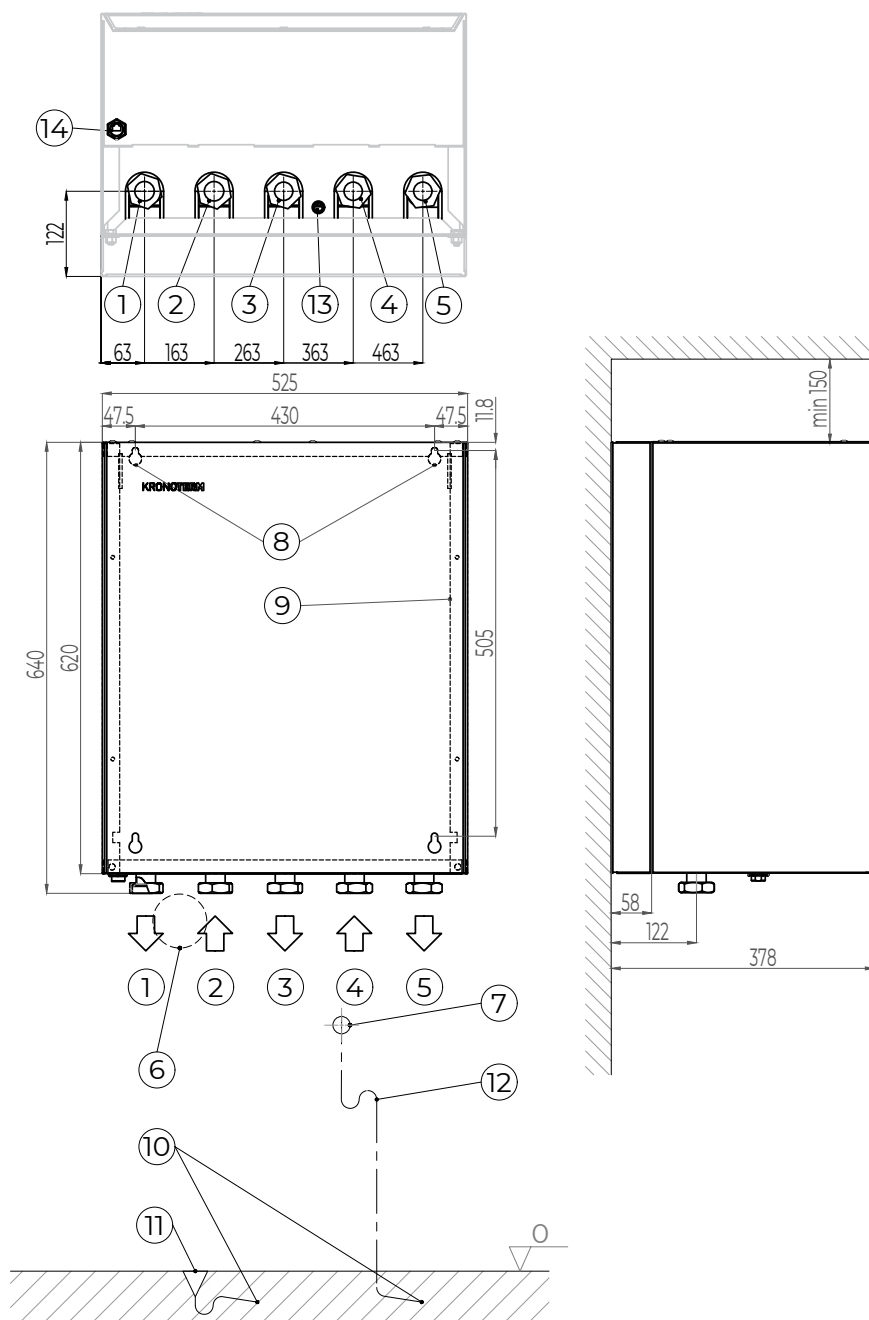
Annexe 3 — Plan d'installation de HYDRO S2 + HYDRO A2
